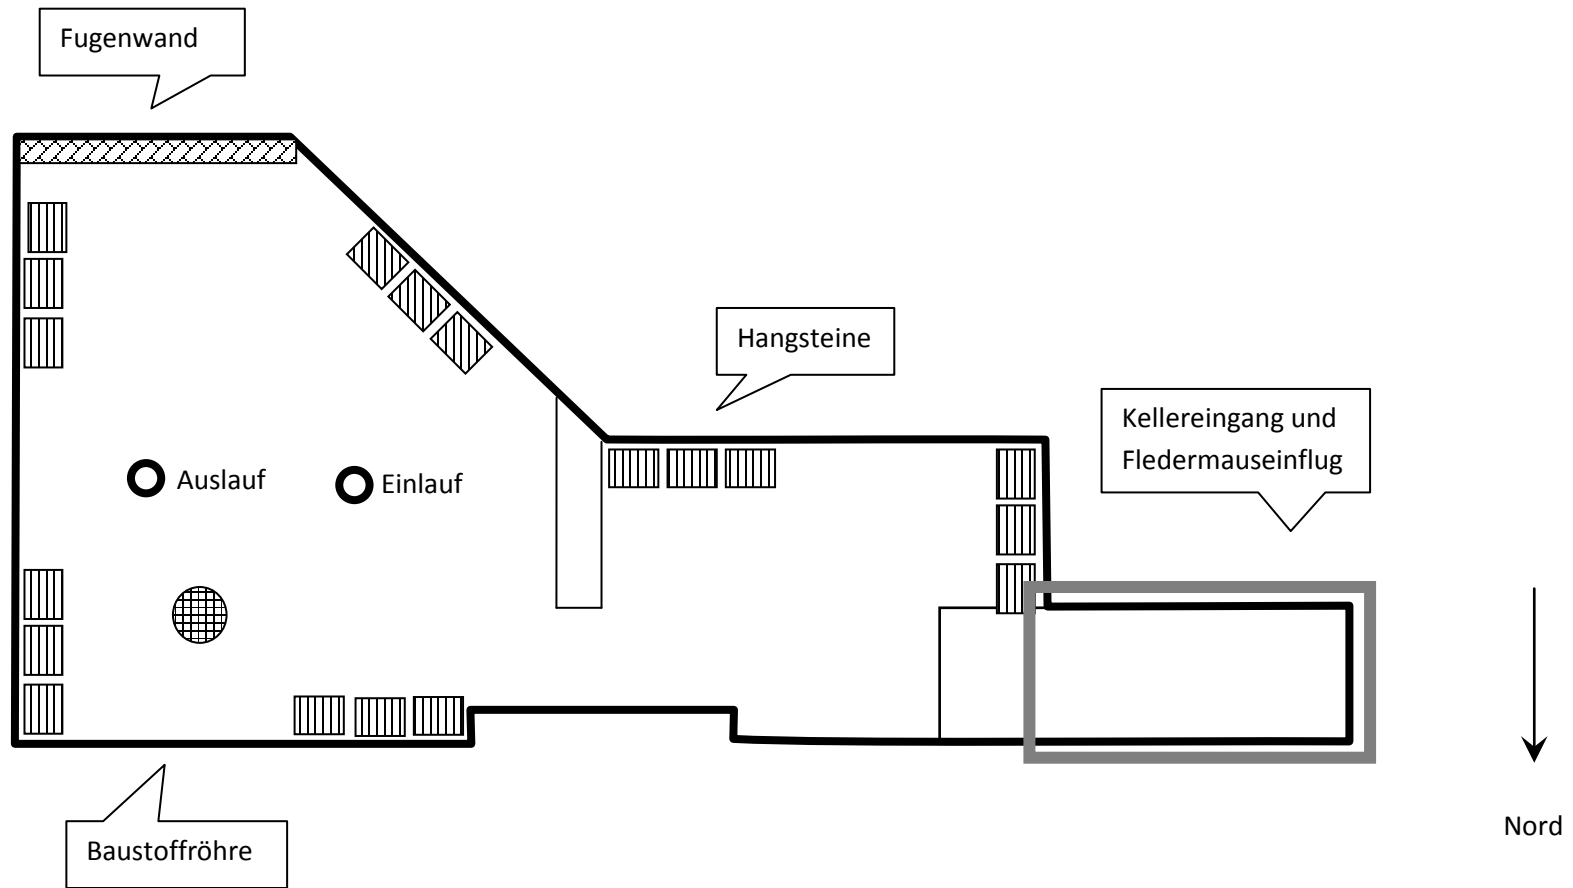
Grundriss des Kellers mit abgerissenem Schornsteinsockel und Rußfang und den eingetragenen Einbauten
